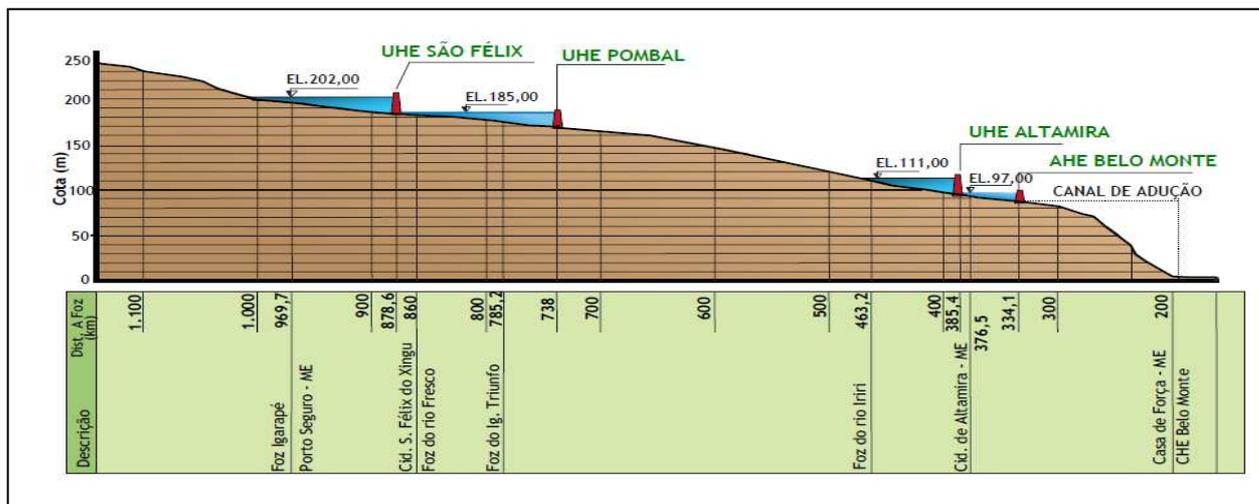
Alternativa 2 - Perfil longitudinal do rio Xingu com as quatro barragens projetadas (Revisão do Inventário).
